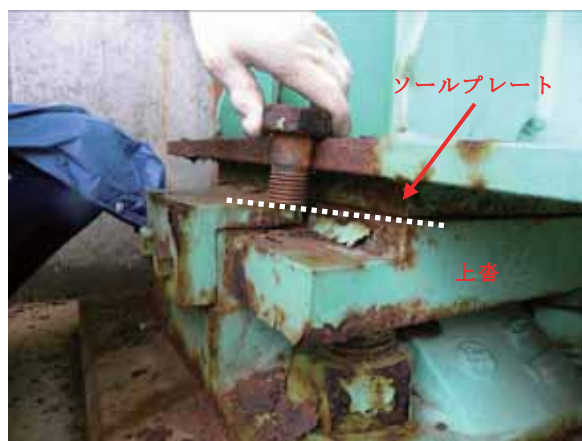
A2 橋台支承部のセットボルト破断
